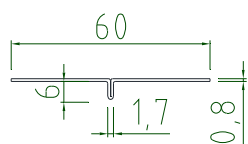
Détail aboutage rails horizontaux à joints ouverts - Ossature bois
